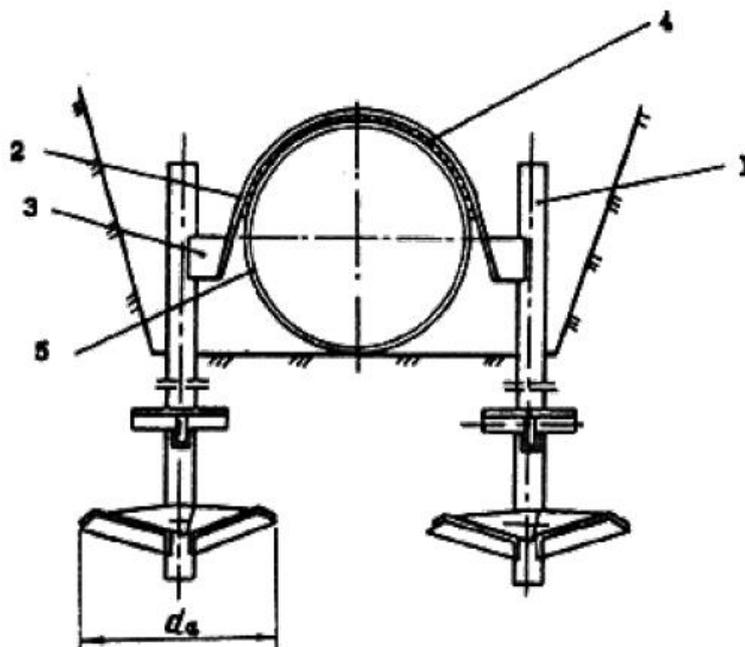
Конструкция анкерного устройства раскрывающегося типа
